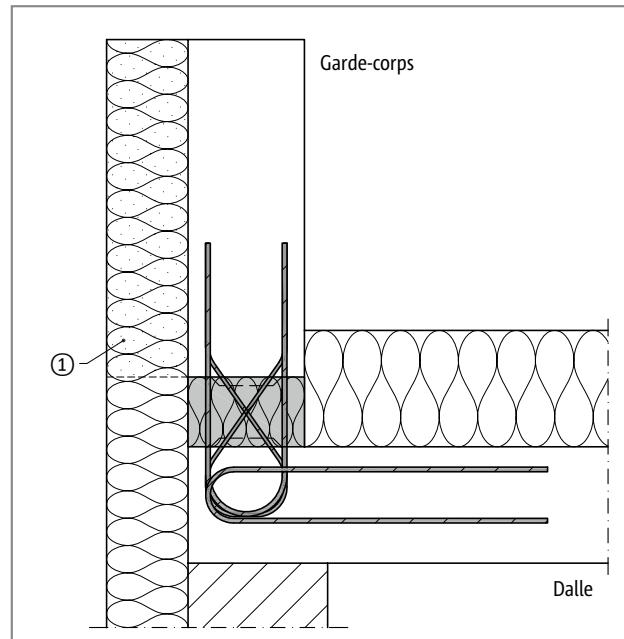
Schöck Isokorb® T Type A : Raccordement sur garde-corps (Type A-MM2-VV1)
